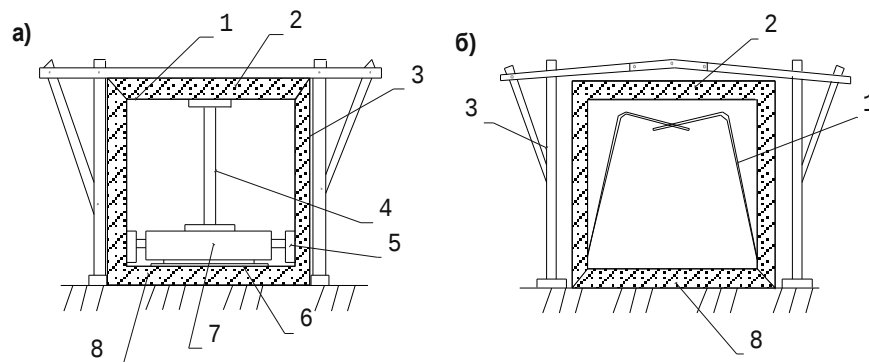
Котюча опалубка для бетонування тунелів:
